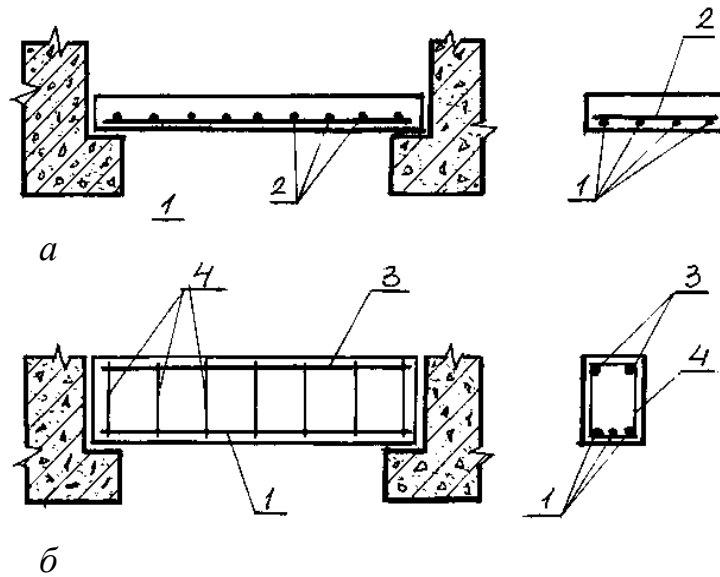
Схема армування: *а* – плити; *б* – балок; арматура: 1 – робоча; 2 – розподільна; 3 – монтажна; 4 – поперечна
